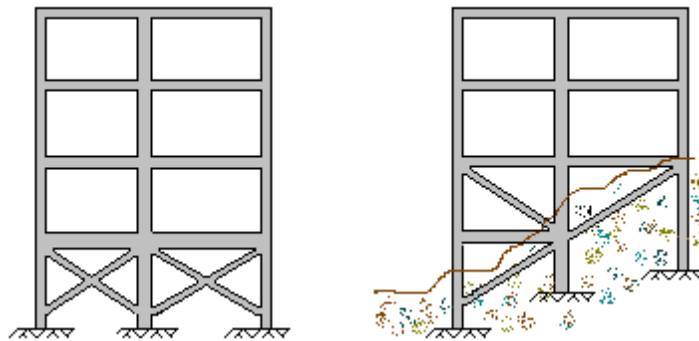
Vigas para Arriostramiento en Edificios Construidos en Laderas.
